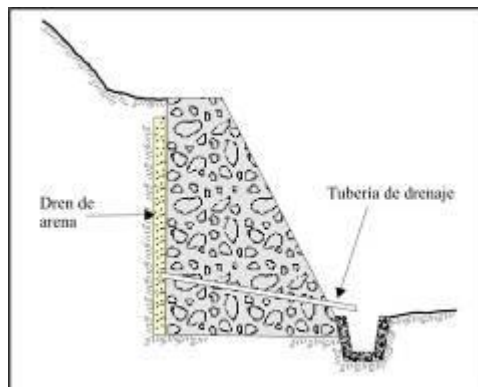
Muros de gravedad de concreto ciclópeo (tomado de INGEMMET, 2000).
